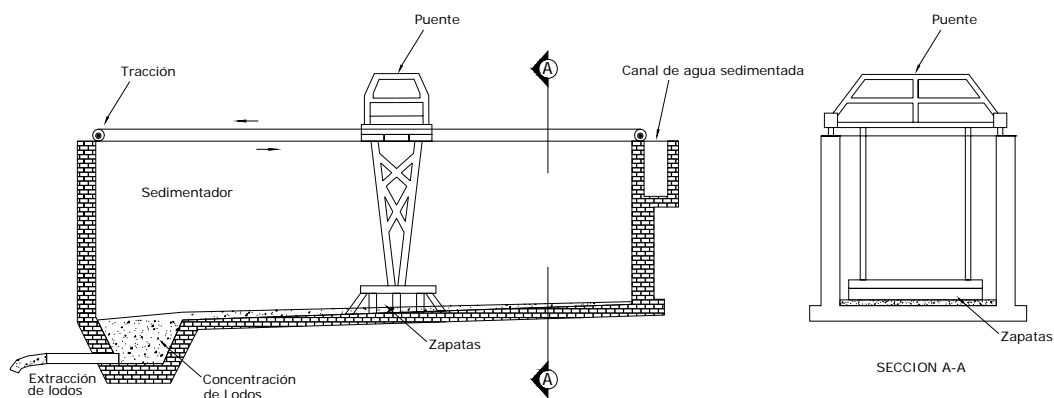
Detalles del sistema de barrido de lodos por cadenas en un tanque rectangular
